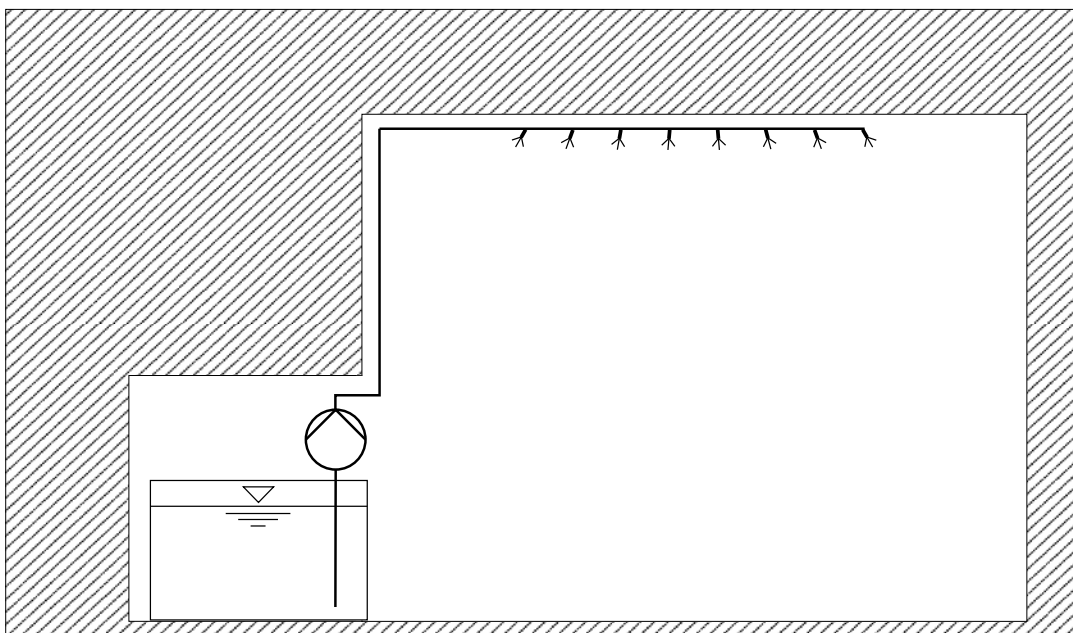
Vorgeschlagene Positionierung einer stationären Bedüsungsanlage in einer Erweiterung des Streckenquerschnitts
